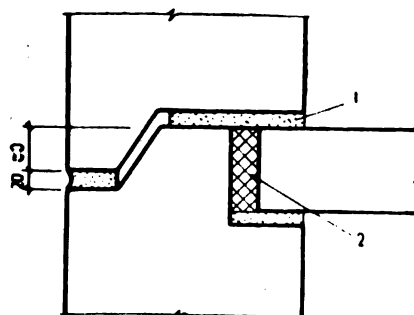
Схема горизонтального стыка панелей наружных стен с устройством противодождевого барьера
